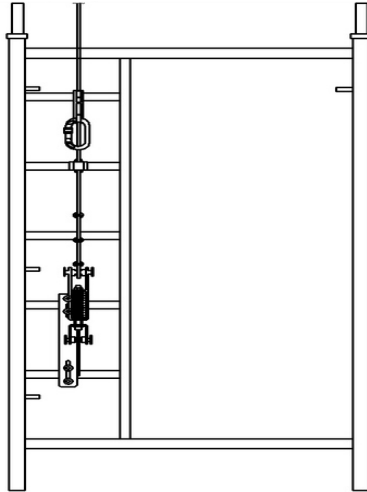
Размещение вертикальной тросовой анкерной линии на лестнице строительных лесов
